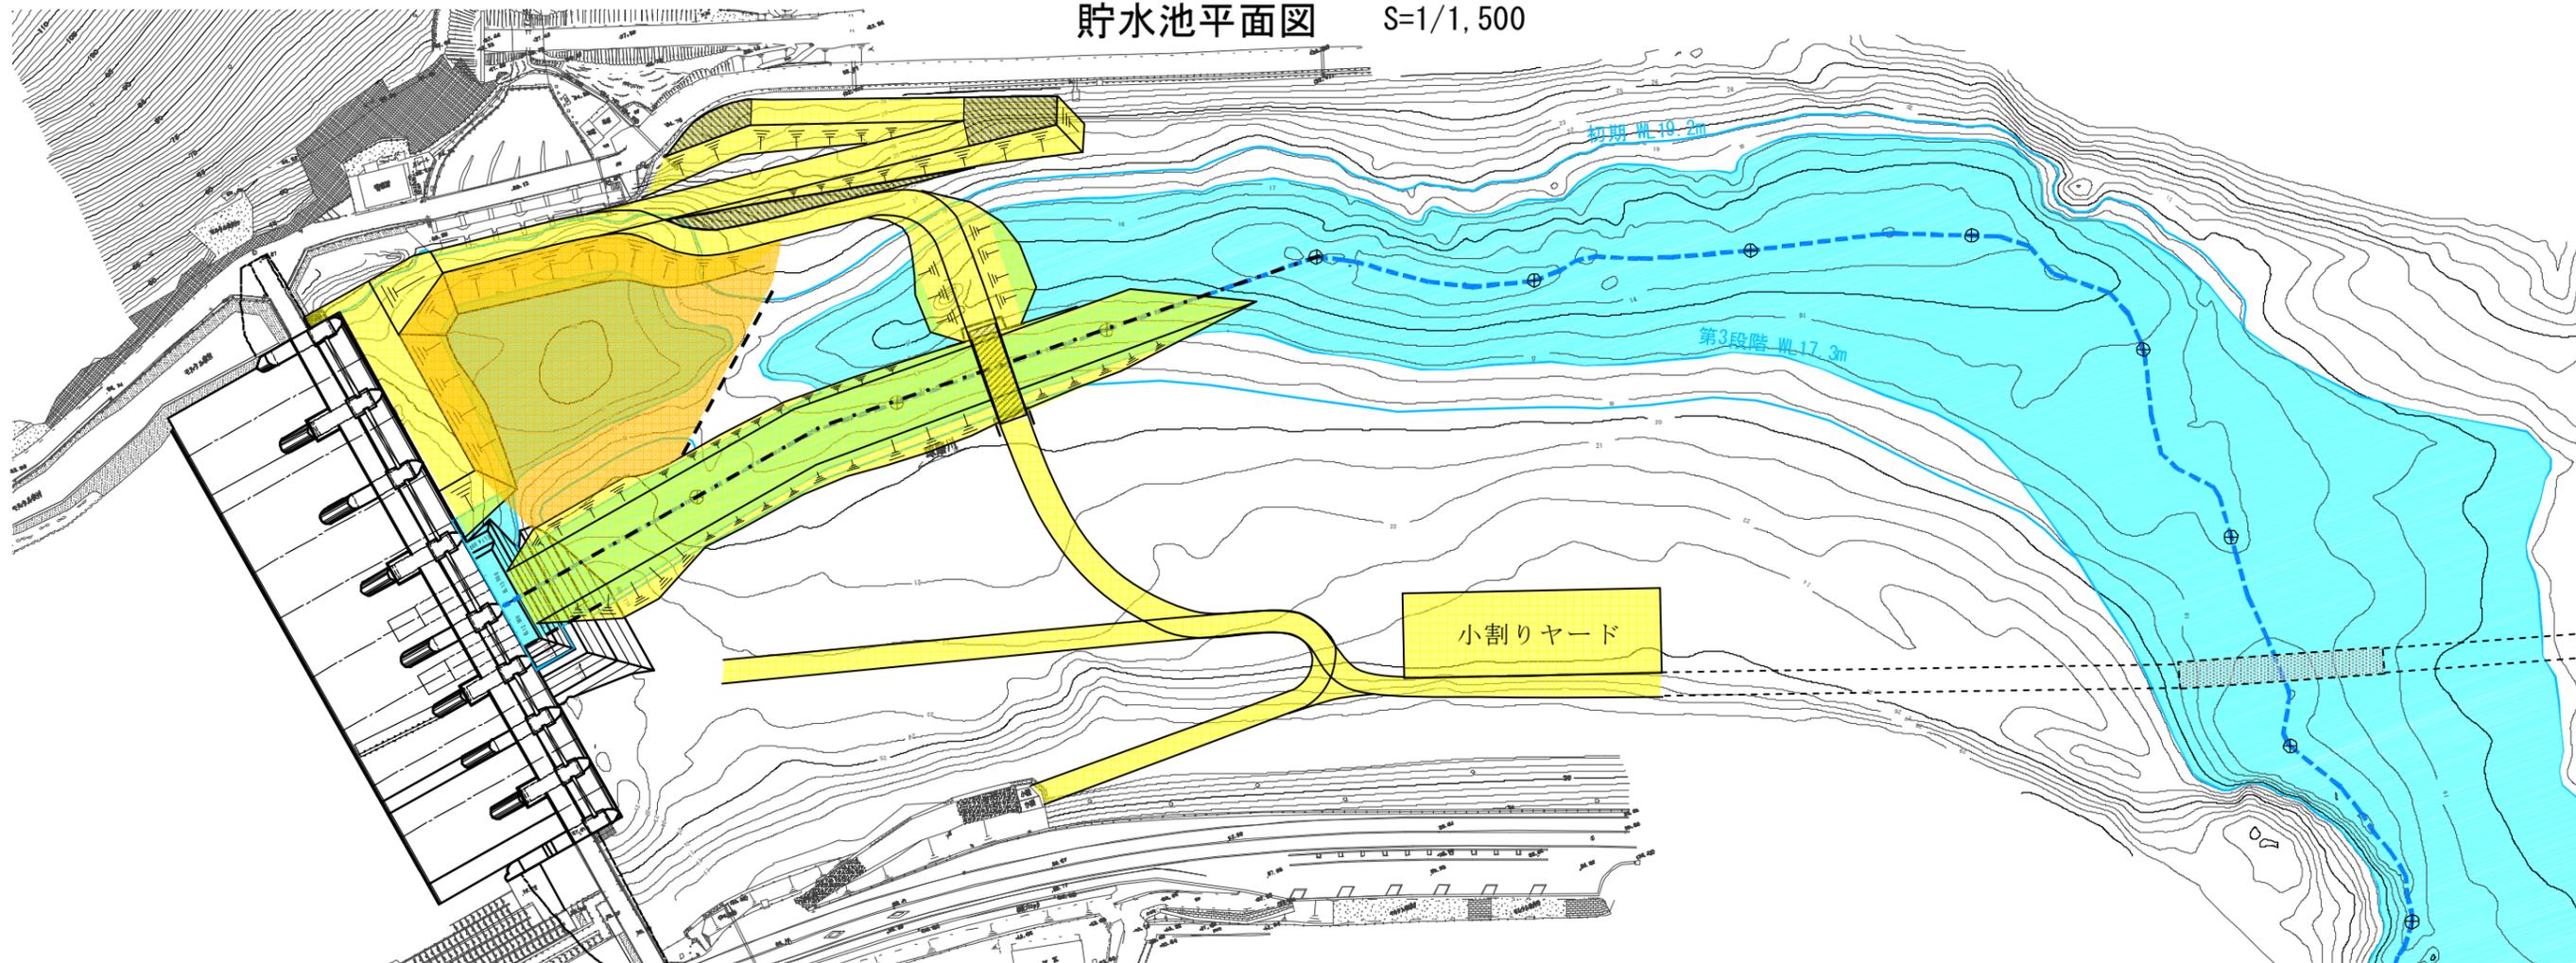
撤去箇所平面図 (見直し案:平成26年度)
